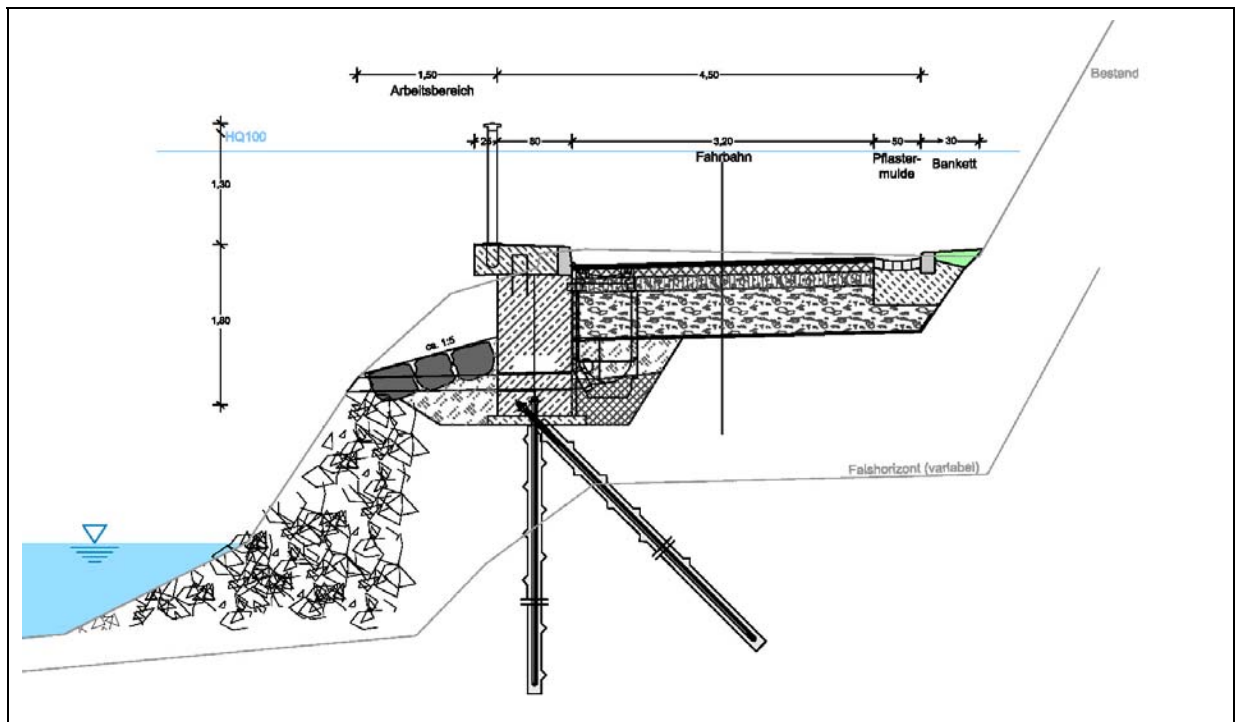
Regelaufbau des Stahlbeton-Kopfbalkens mit Gründung/Verankerung mittels Mikrobohrpfählen, dem Straßenkörper und der Entwässerung
